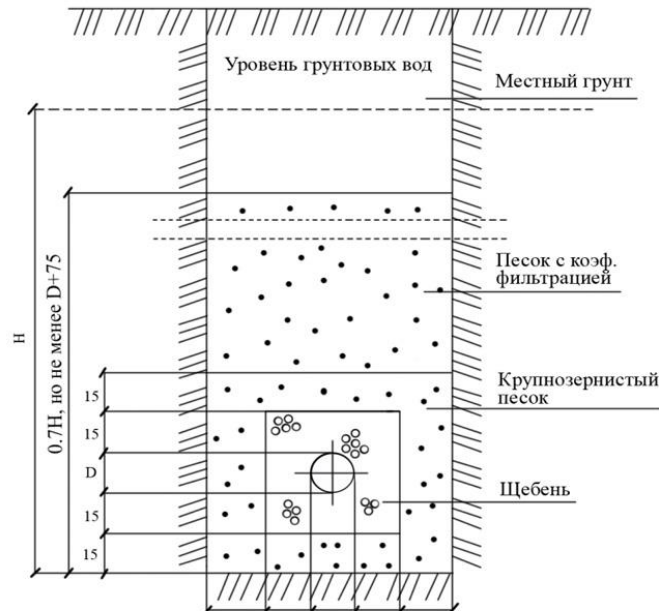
Прямоугольная засыпка дренажа несовершенного типа
